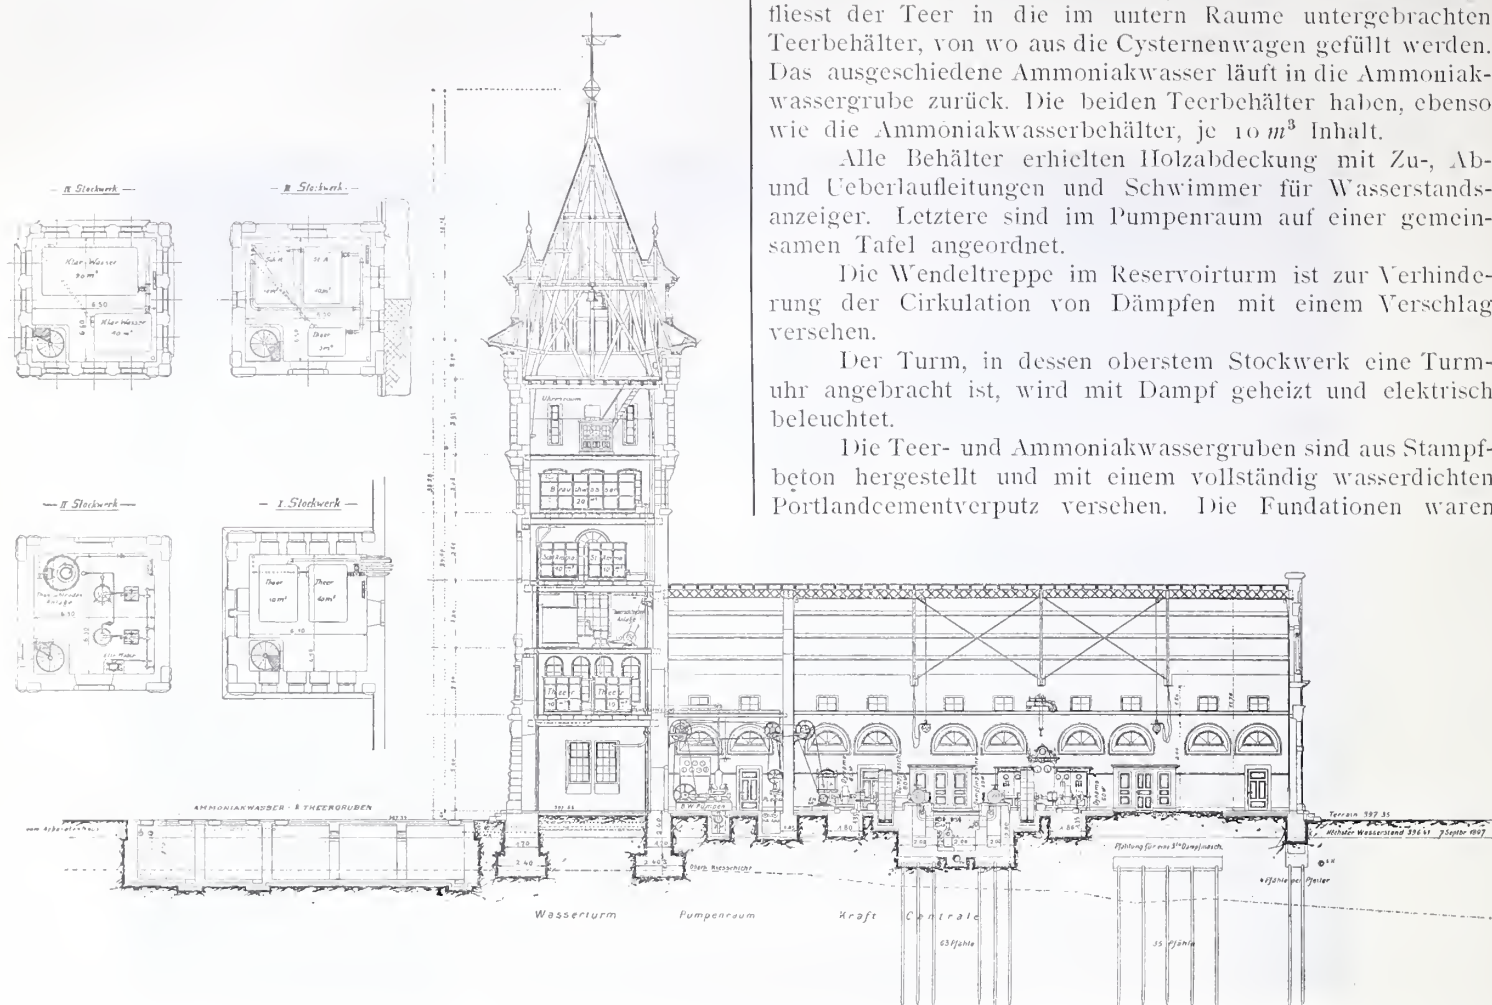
Grundrisse des Wasserturmes, Längenschnitt durch Teergruben, Wasserturm und Kraftcentrale.
